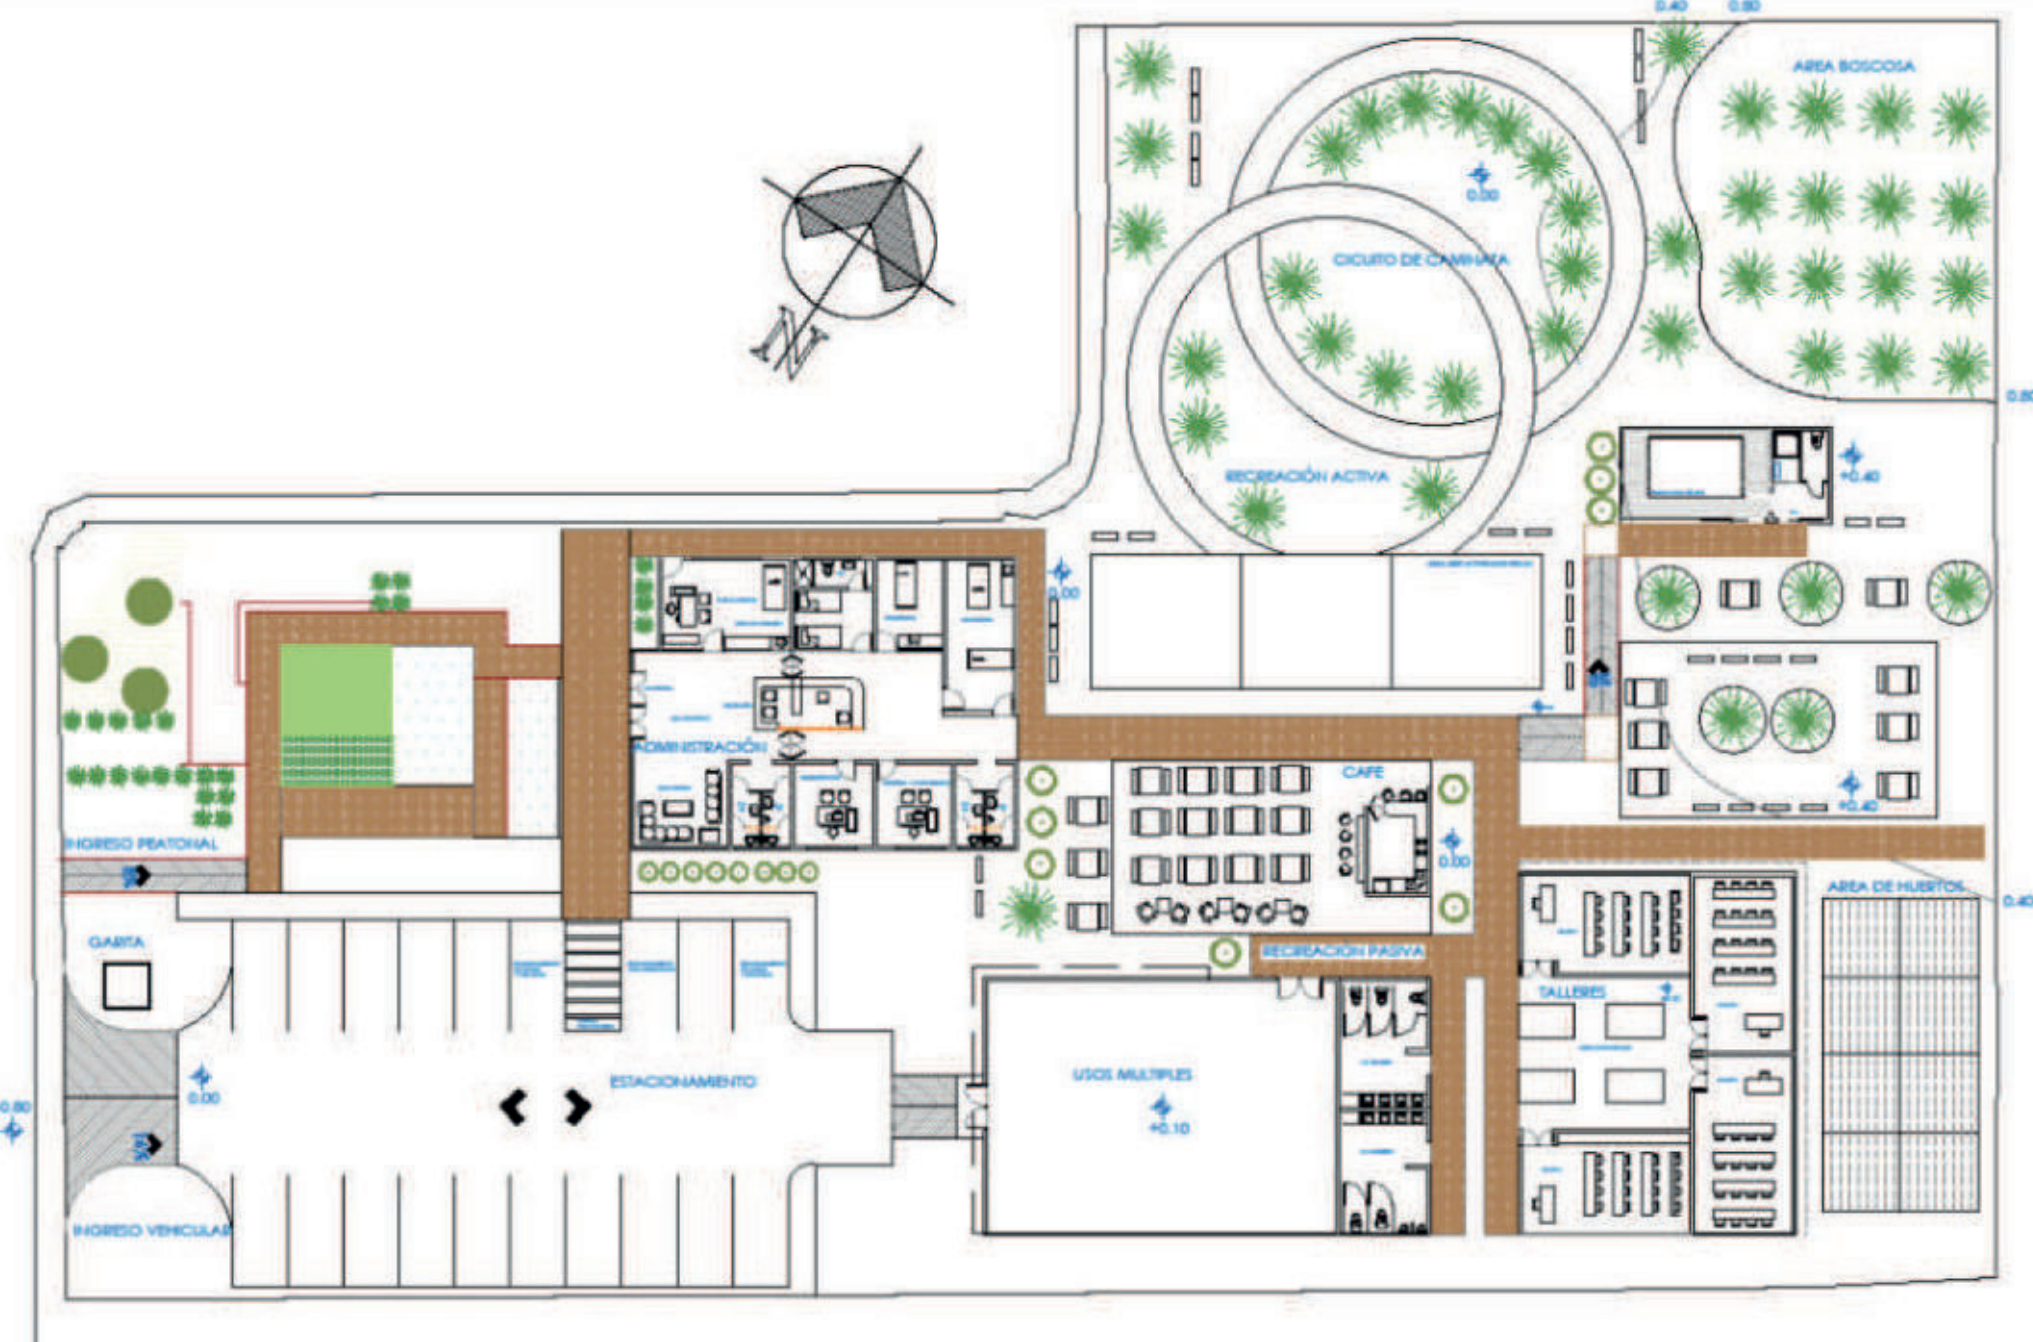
Planta arquitectónica del parque geriátrico de la zona 2 de Mixco Tesoro Banvi, Elaboración: María del Rosario
